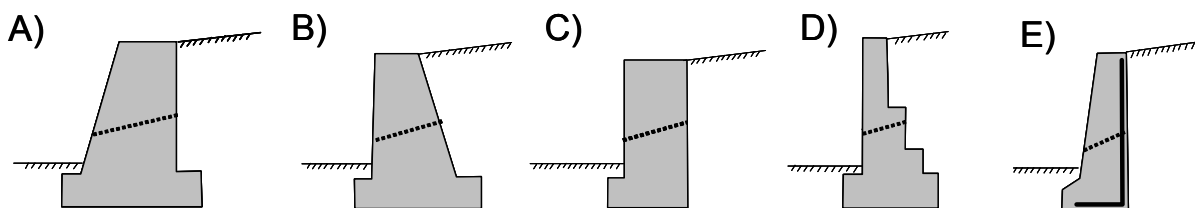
Alcune tipologie di muri a gravità: A) muro a gravità con paramento frontale inclinato; B) muro a gravità con paramento posteriore inclinato; C) muro a gravità di forma semplice; D) muro a gravità con paramento posteriore a gradini: in questo caso la stabilità è assicurata, oltre che dal peso della struttura, dal terreno che grava sul tetto dei vari gradini; E) muro a semigravità con rinforzi in acciaio (ad L) nella parte posteriore -
